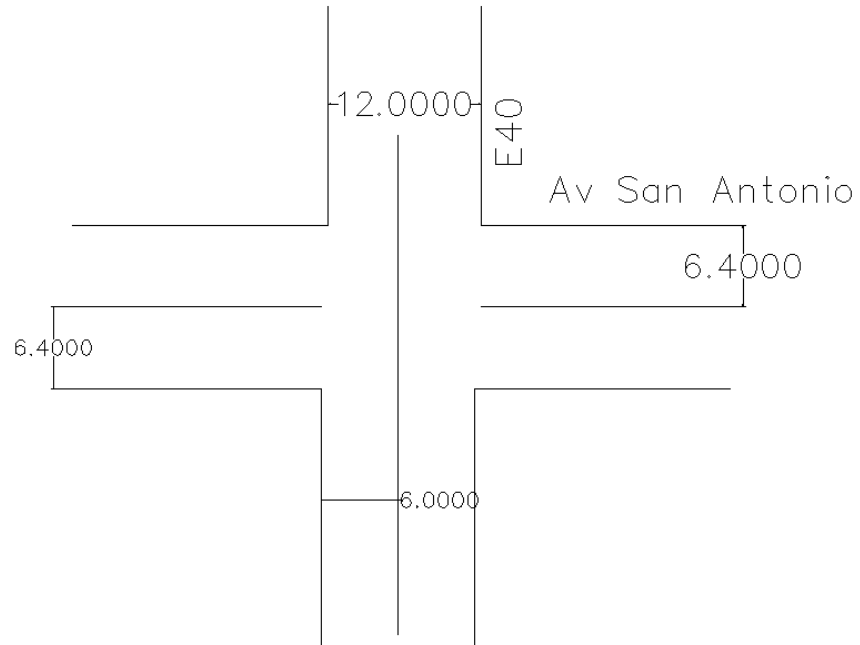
Geometría de la intersección 2. Fuente: Elaboración Propia
